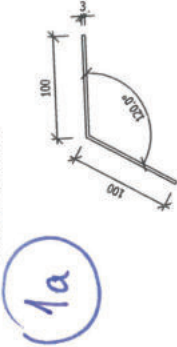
Instalace dodatečného hravolu u světlíků:
